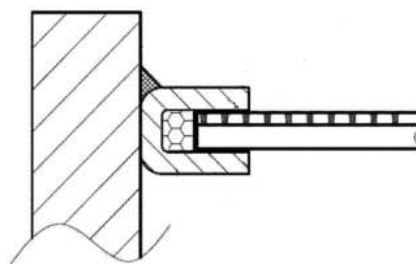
Схема опорного пристрою згідно з пат. № DE2840145A1
